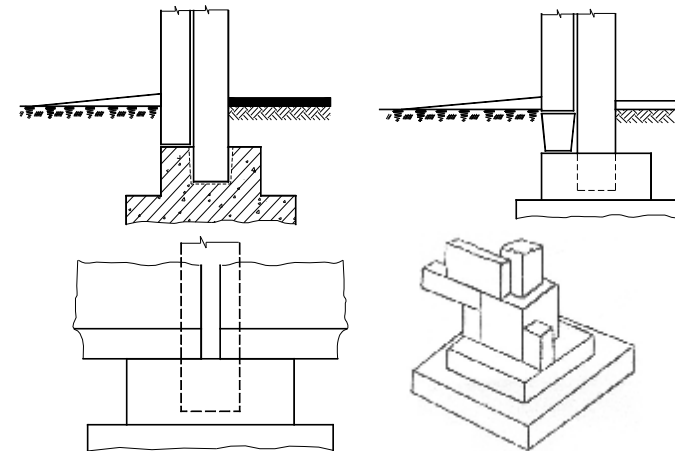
Примеры опирания цокольных панелей, фундаментных балок на отдельные фундаменты.
